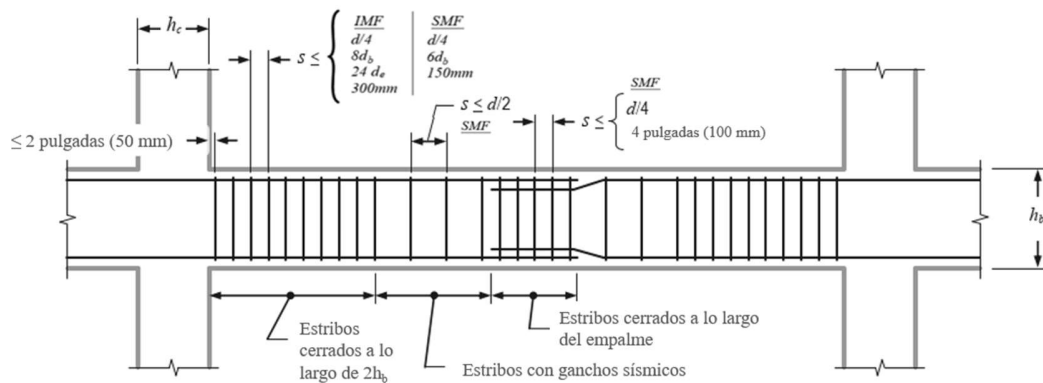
Disposición de estribos en vigas. Adaptado de: NIST GCR 16-917-40, 2016.
